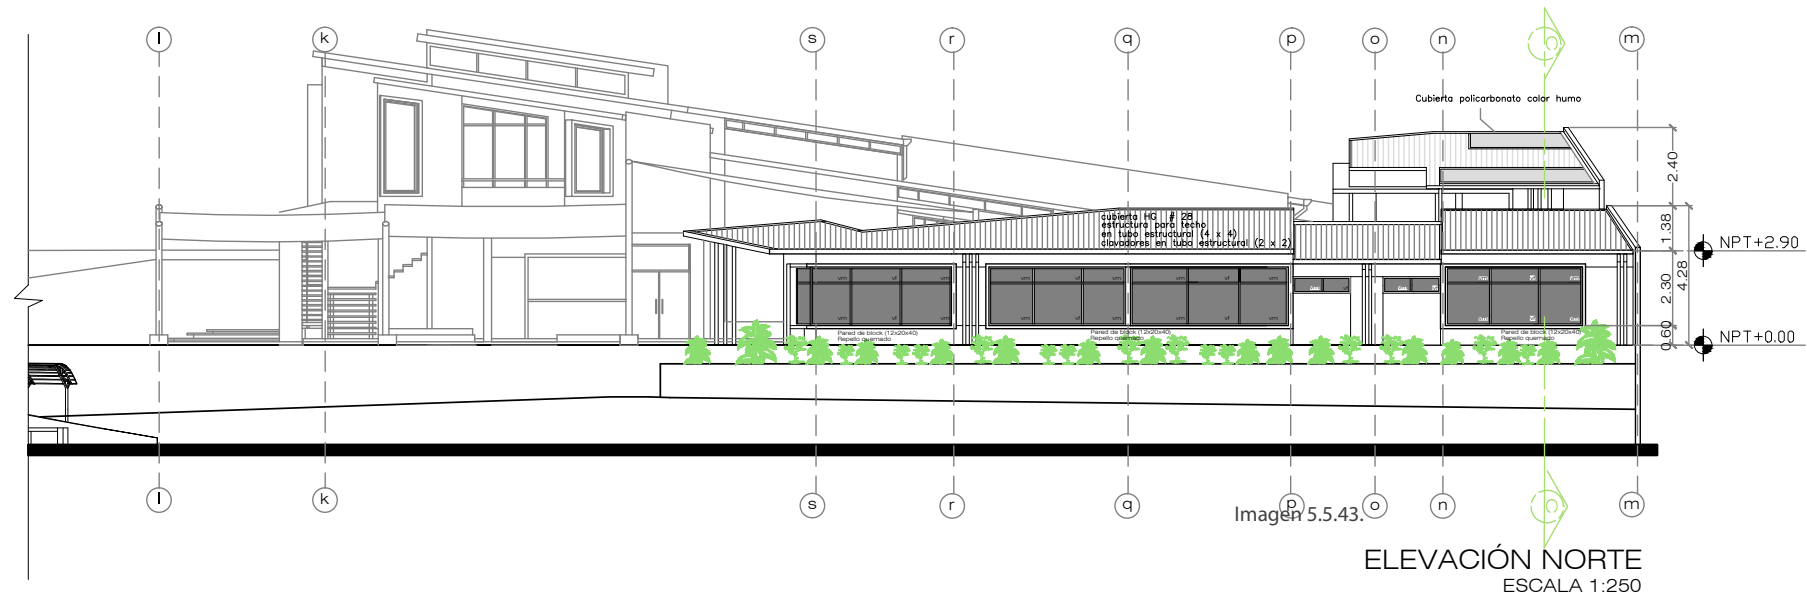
ELEVACIÓN NORTE ESCALA 1:250
